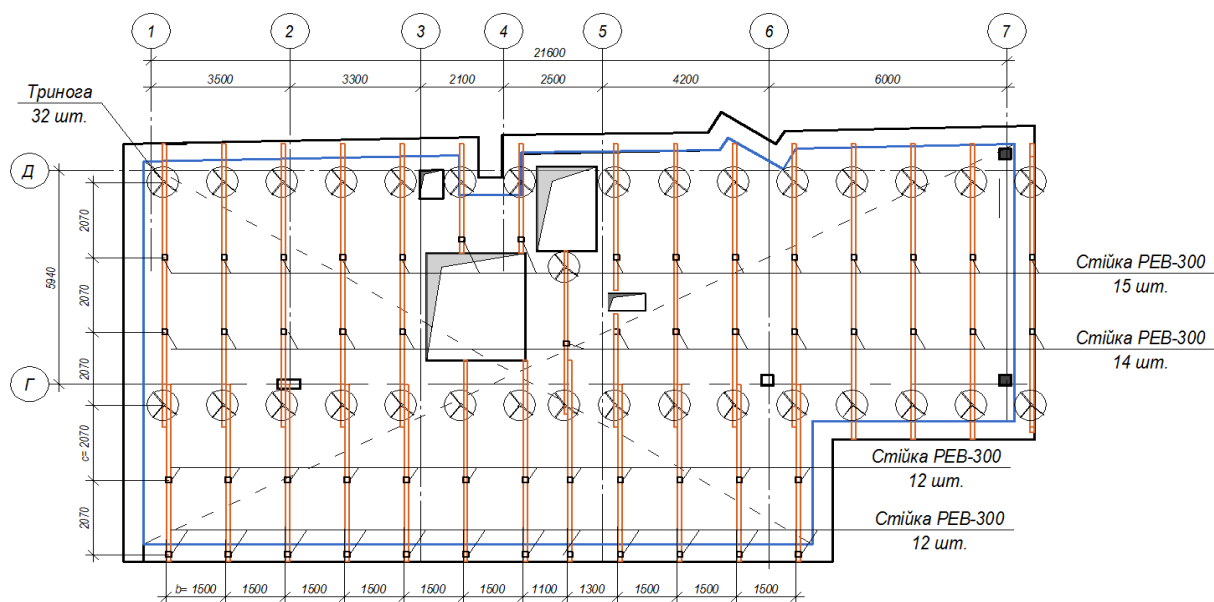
Схема розкладання елементів опалубки на рівні балок нижнього ярусу на першій захватці
